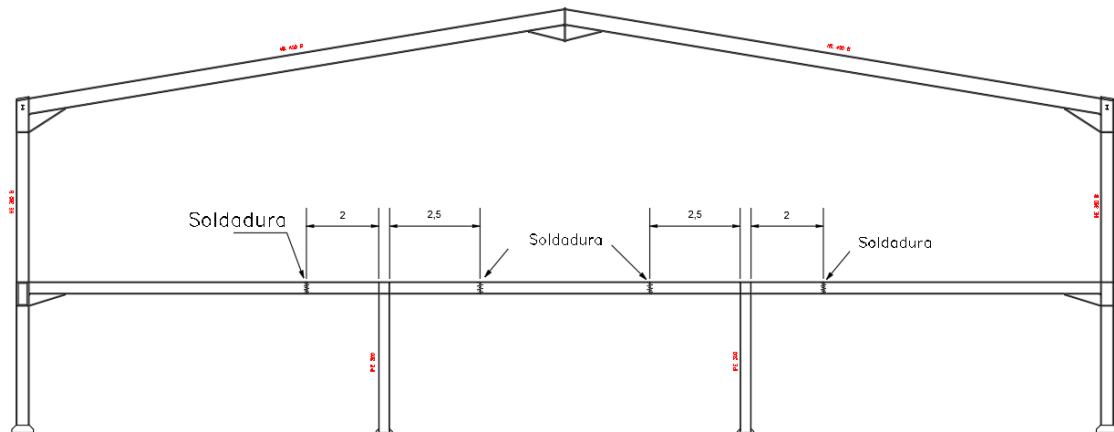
Posición de las soldaduras para unión entre perfiles.
